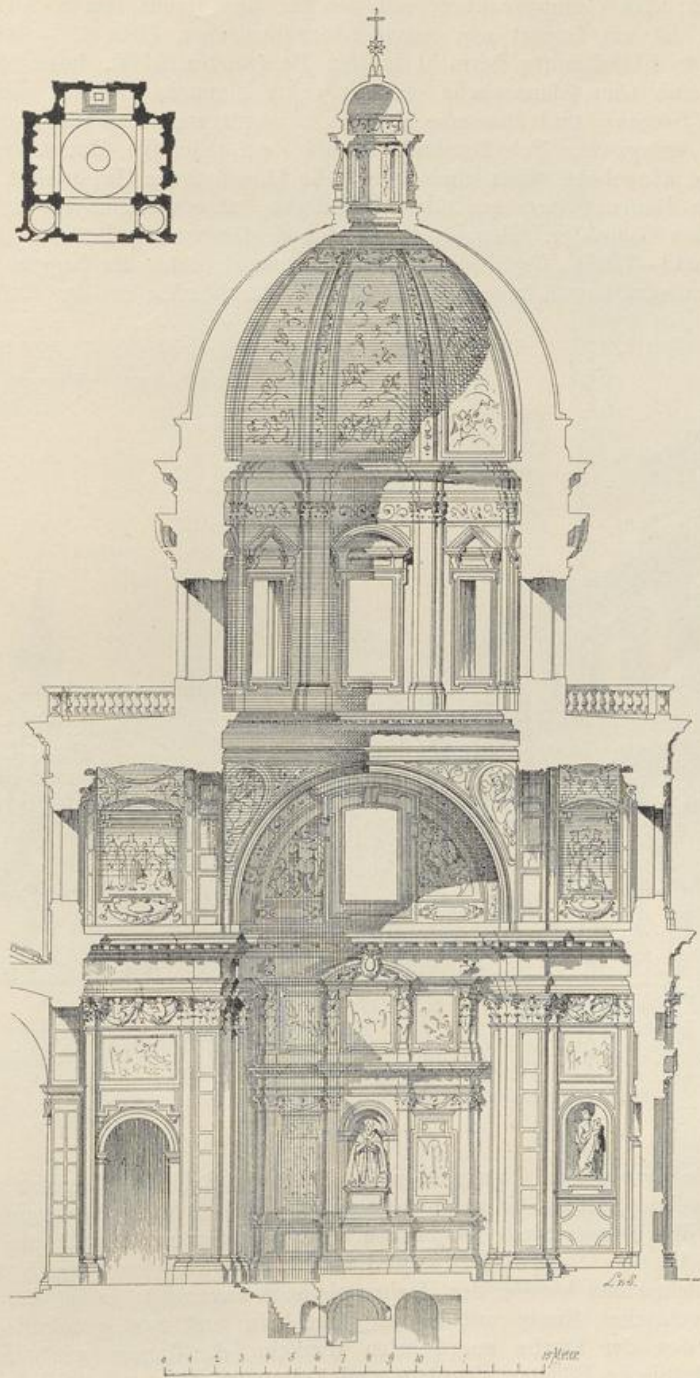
Längsschnitt und Grundriss der Cappella del Presepio an S. Maria Maggiore
